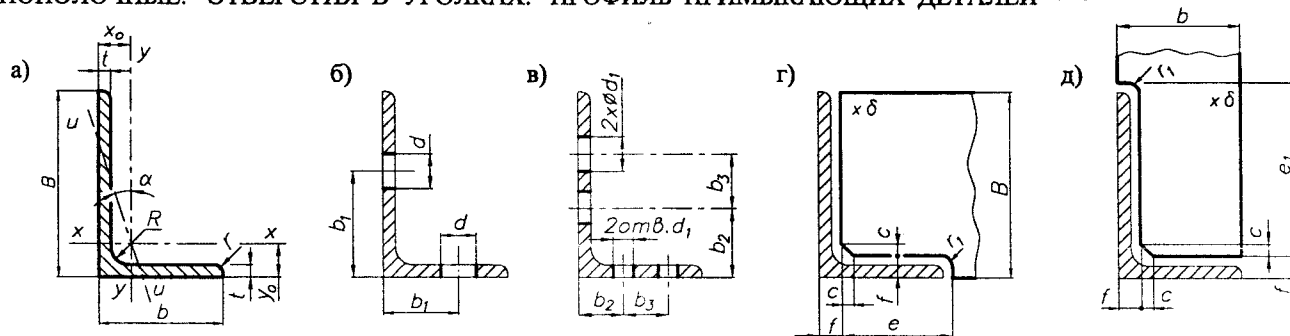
Уголки неравнополочные: а) размеры поперечного сечения; б), в) отверстия в уголках при однорядном и двухрядном расположении отверстий соответственно; г), д) размеры профиля примыкающих деталей
